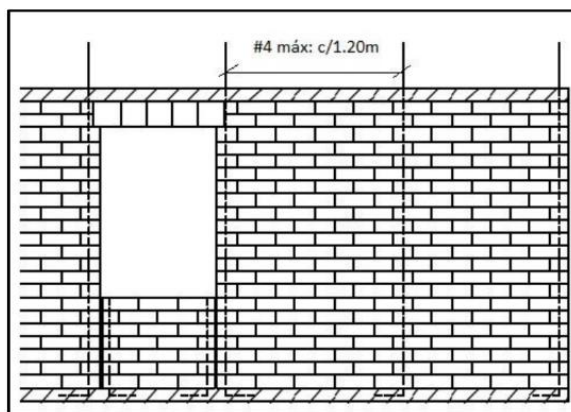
Mampostería reforzada. Fuente: Rodríguez (2015).
